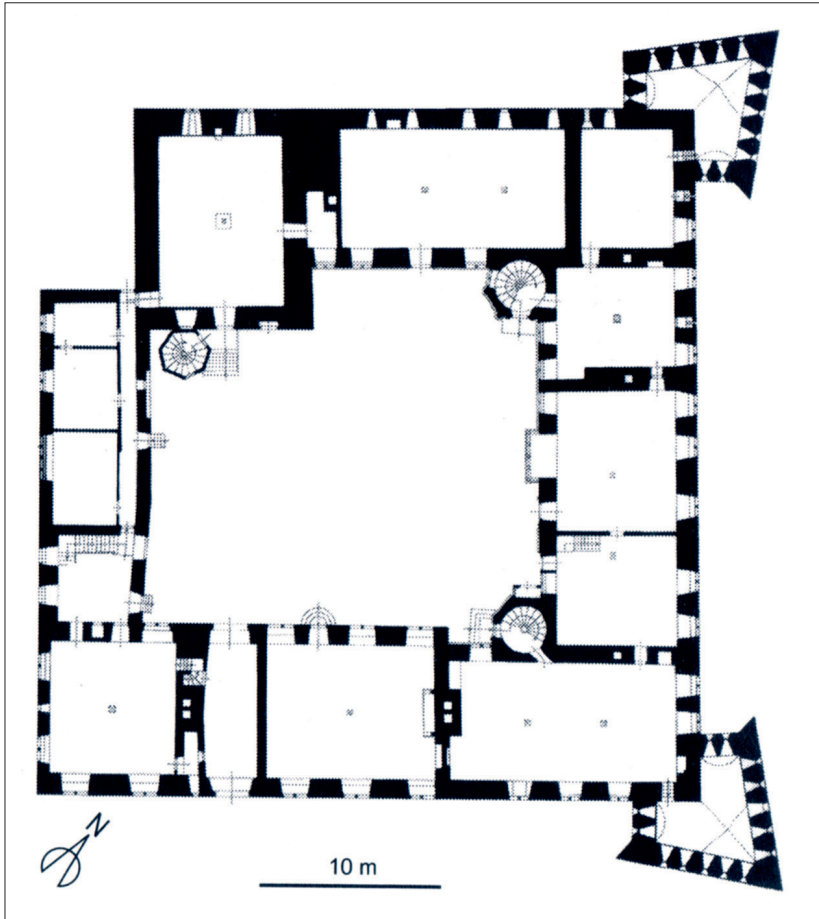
Kalletal-Varenholz, Krs. Lippe. Grundriss des Schlosses mit Eckbastionen, die im oberen Bereich zu Wohnzwecken überbaut sind.
